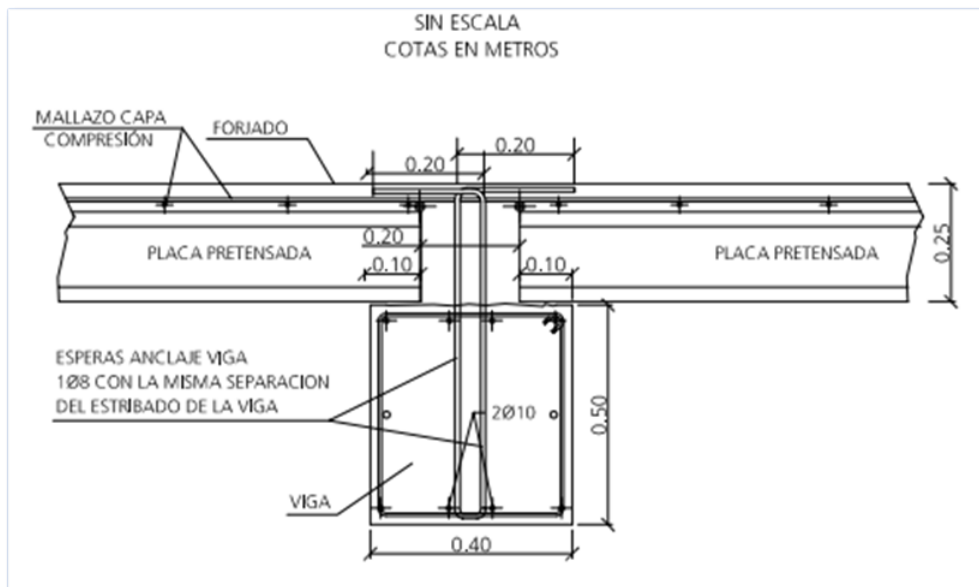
Detalle de apoyo de forjado en vigas de pórticos entre pilares
